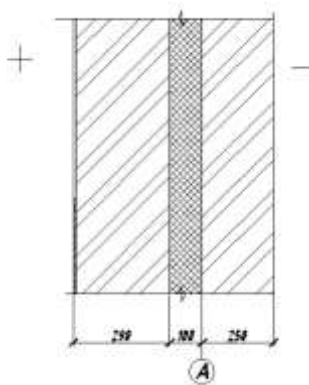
Расчетная схема стеновой ограждающей конструкции
